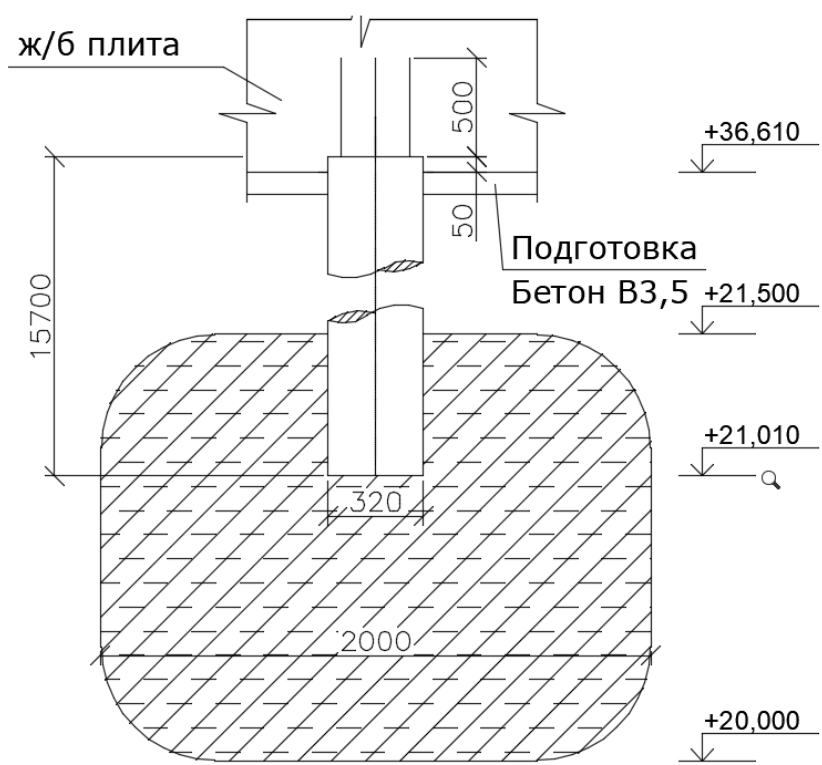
Узел сопряжения сваи и с плитой и заделки в закреплённый грунт
